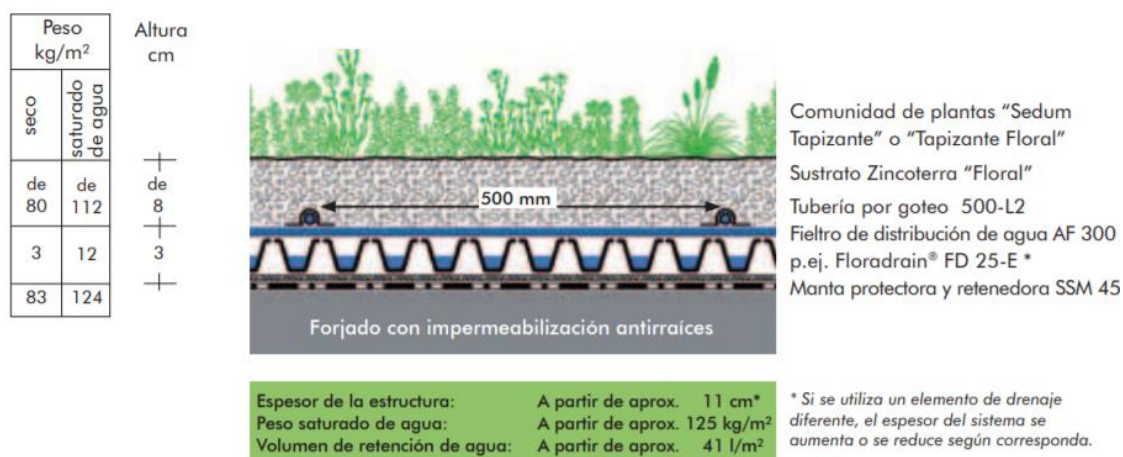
Secció constructiva sistema "Cubierta verde extensiva con riego integrado".
